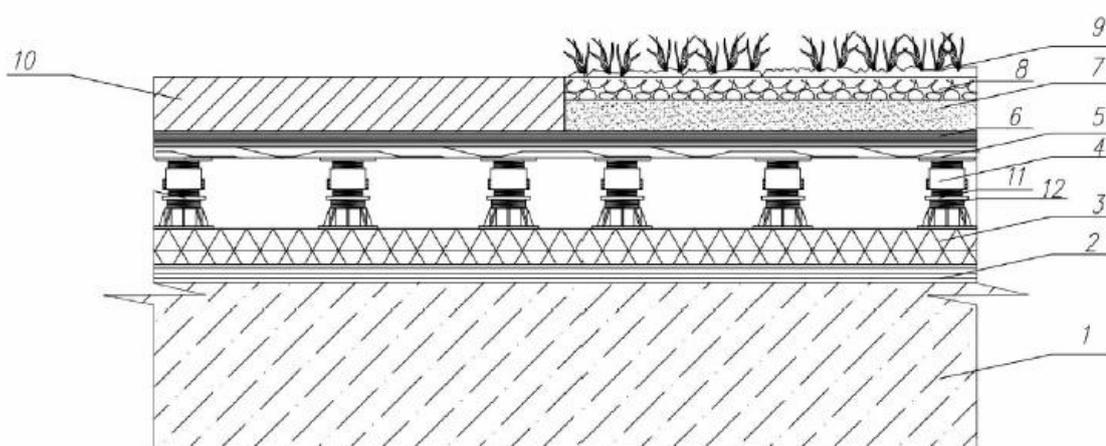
Устройство зеленой кровли, предназначенной для монтажа на общественных зданиях: 1 – железобетонная плита перекрытия, 2 – настилающий слой еврорубероида, 3 - слой термоизоляции, 4 – регулируемые опоры, 5 - настилающий слой ондулина, 6 – слой гидроизоляции, 7 – дренажный слой, 8 – грунт, 9 – зеленые насаждения, 10 – террасная доска, 11 – оцинкованные шпильки, 12 – контррейка.
